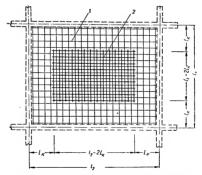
84. План инжией арматуры плиты, опертой по контуру: 1 — основная сетка, укладываемая по назу всей панеле плиты, 2 — дополнительная сетка, укладываемая по низу посередине памели плиты.
